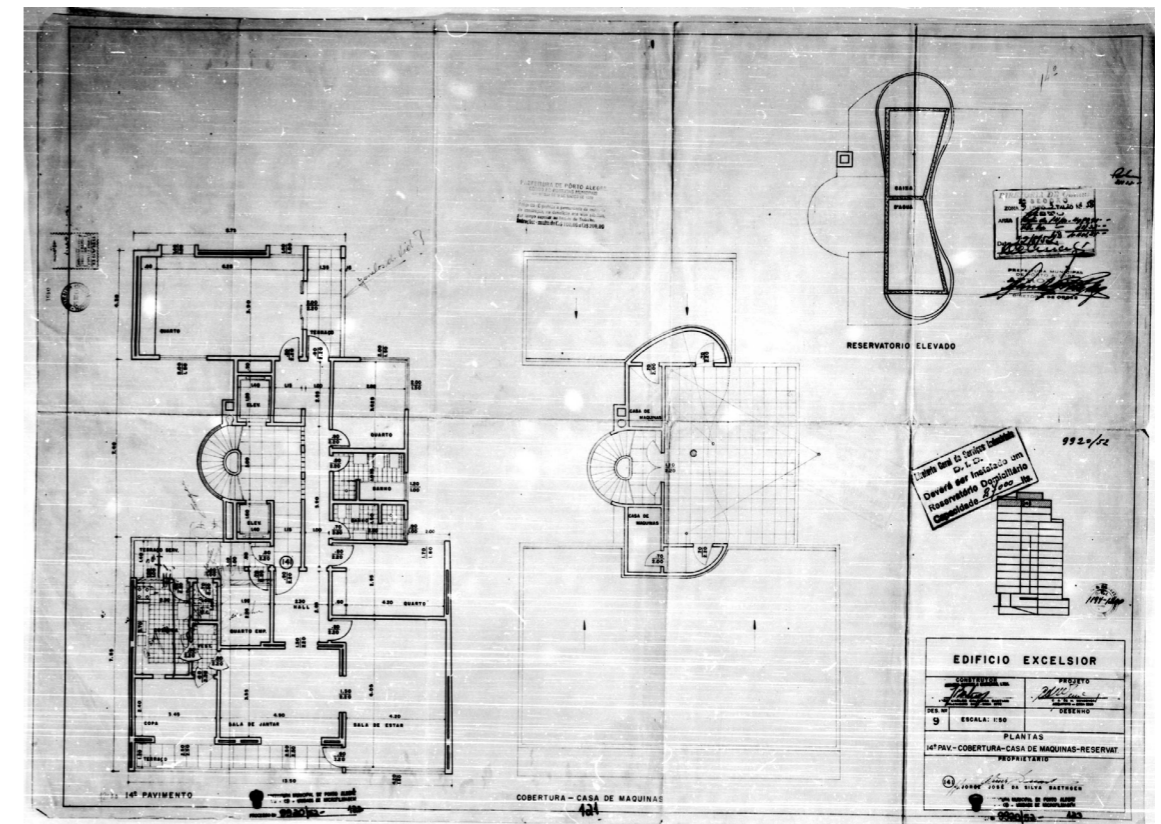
Planta Baixa 14º pavimento e cobertura do Edificio Excelsior. Fonte: BUENO, 2012.
